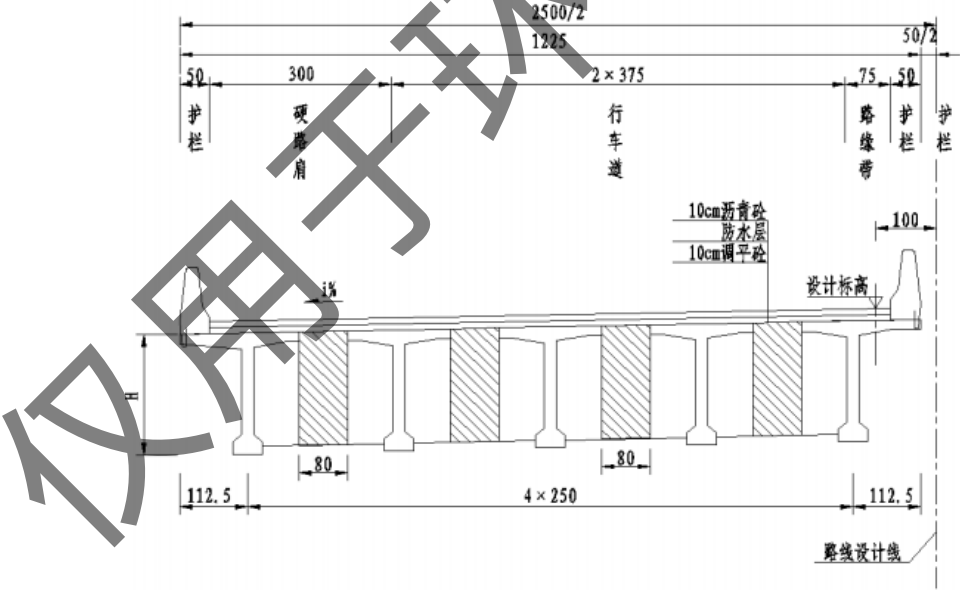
连接线 12.25m 宽 T 梁标准横断面图
